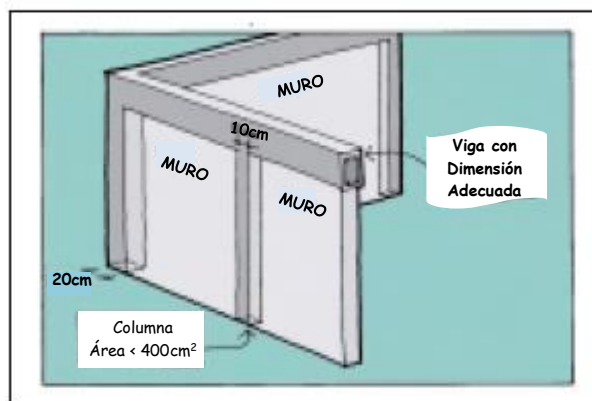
Detalles de Columnas y Vigas de Confinamiento - Chavarría (2001)
